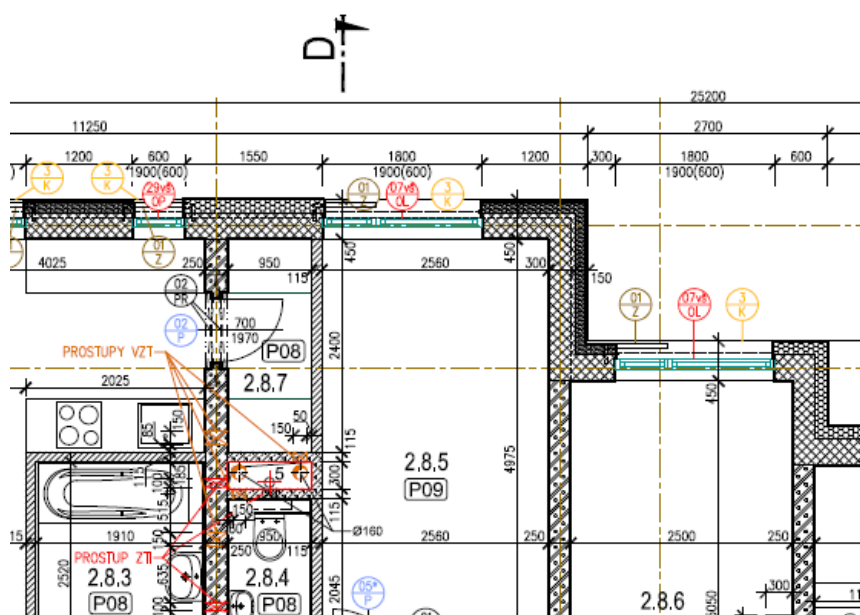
Zdravotně technické instalace – Půdorys 1PP, BD 13
